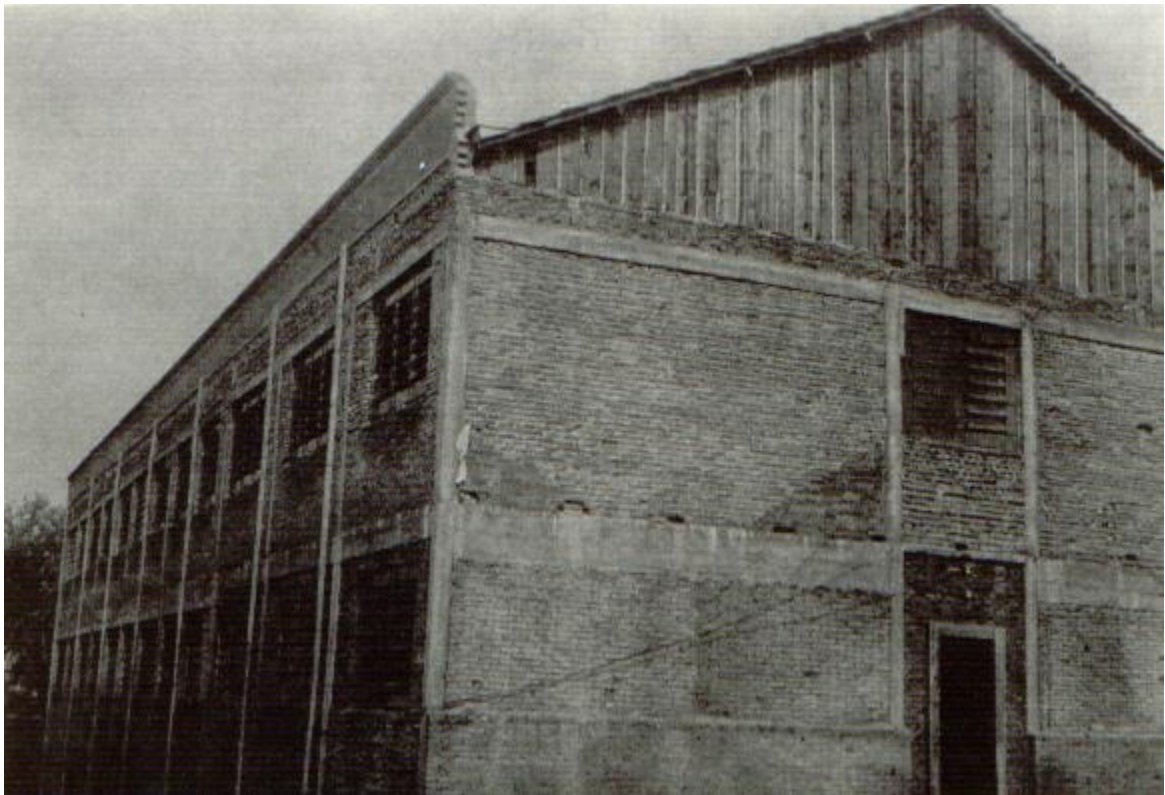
Construção do 1º pavilhão – Arquivo Santa Teresa.
